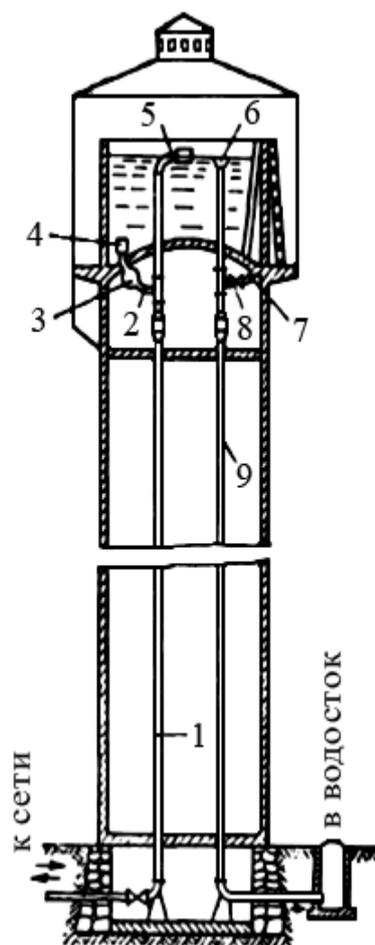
Схема оборудования водонапорной башни трубопроводами
